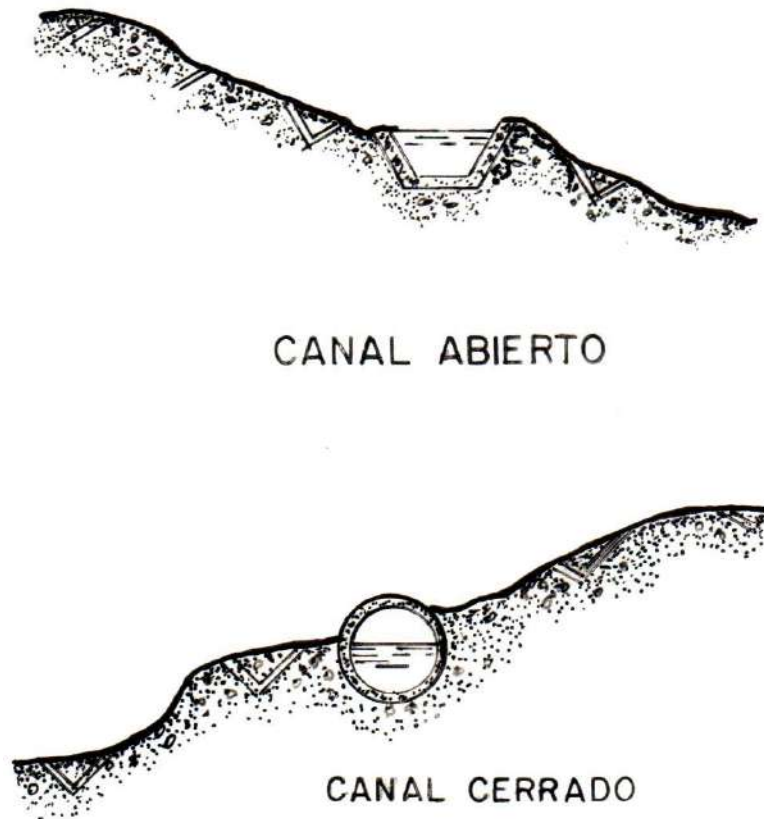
7 Ilustración de canales abiertos y cerrados colocados en ladera.
